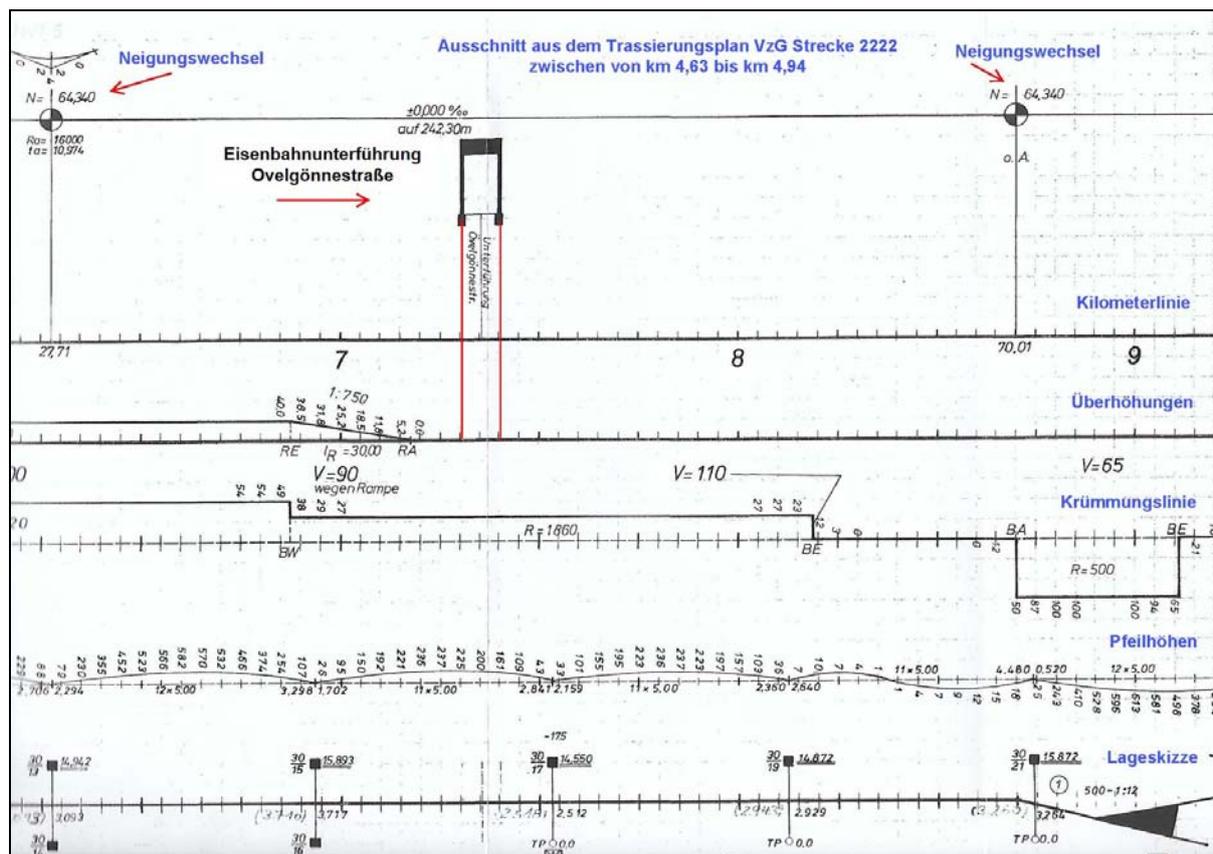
Ausschnitt 2 Trassierungsplan Strecke 2222
